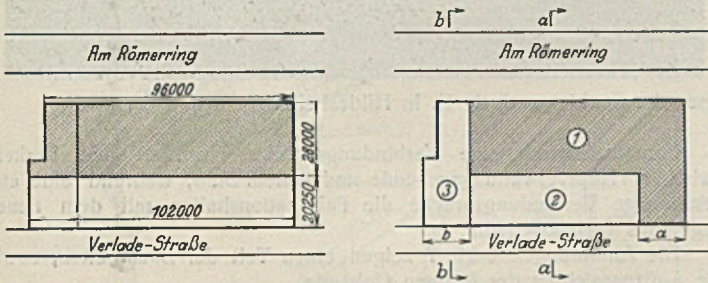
u. 2. Bebauungsplan. ① Lagerhaus ② Versandhalle ③ Bürogebäude
